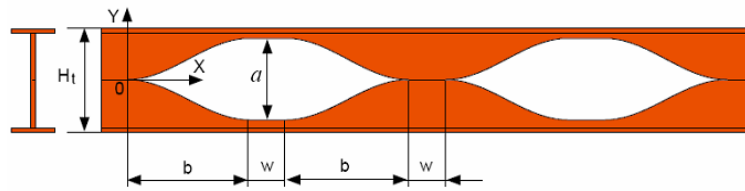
poutrelle Angelina produite par ArcelorMittal.
